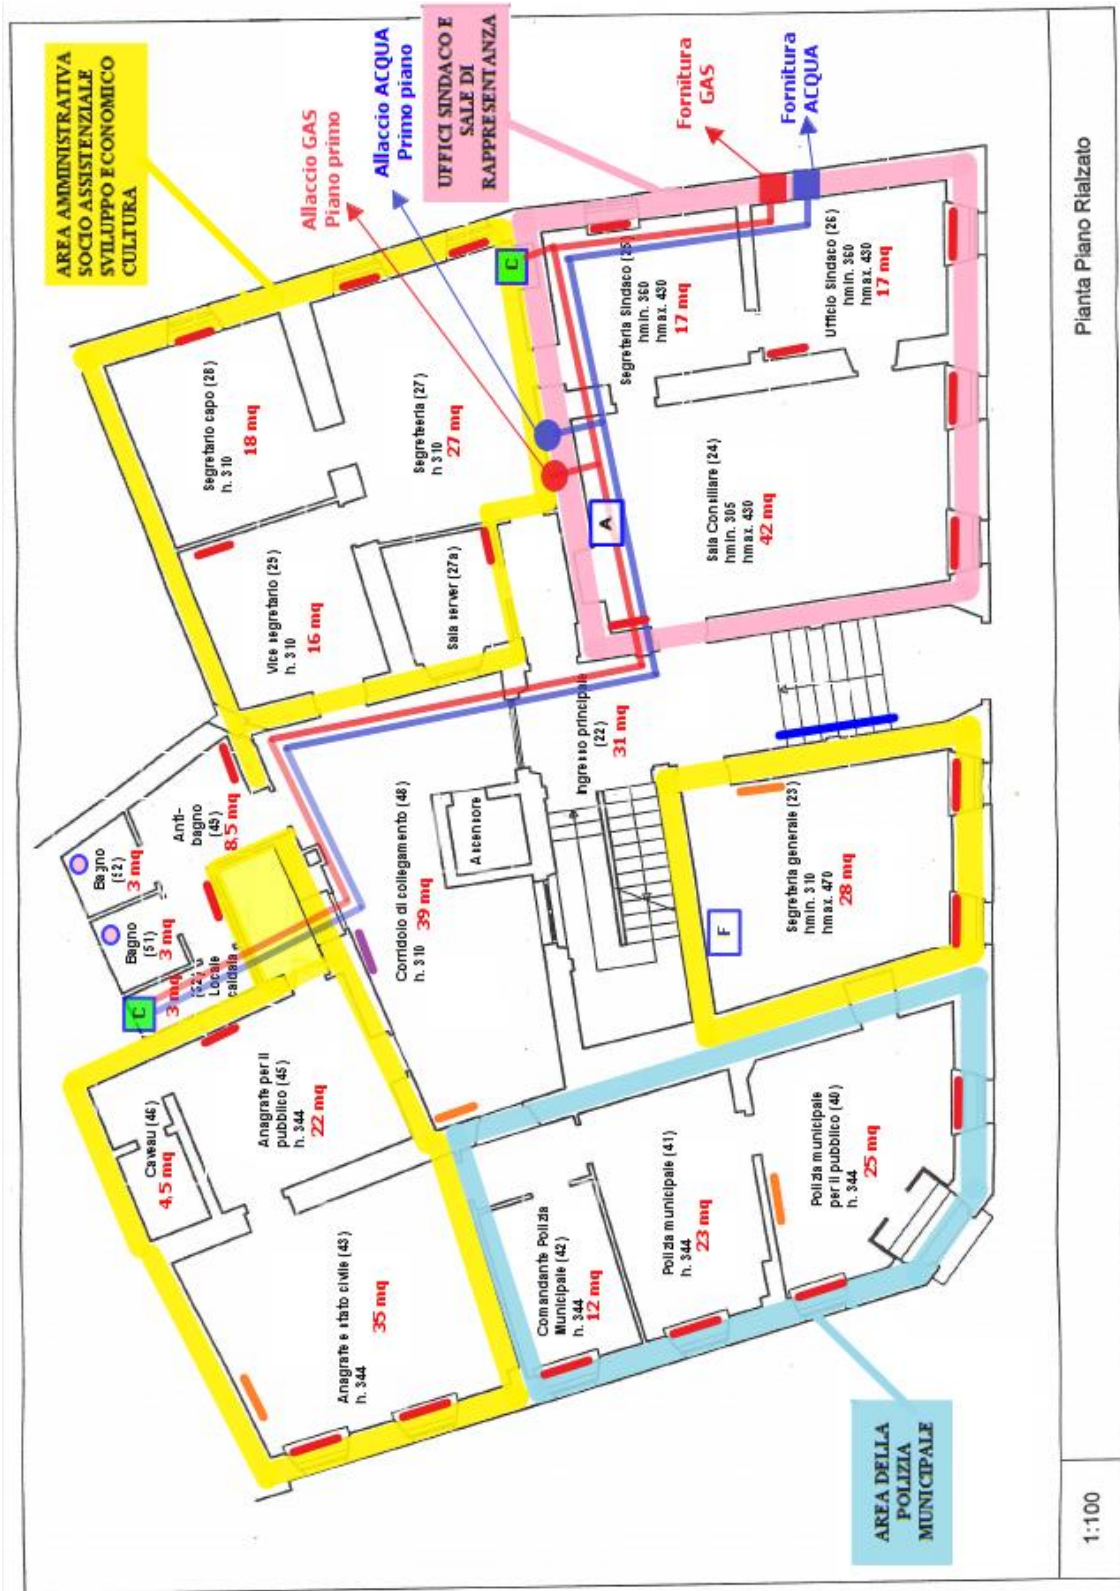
Planimetria del Piano Rialzato completa di suddivisione in aree funzionali e impianti presenti nell'edificio Comunale. (scala non rispettata)
